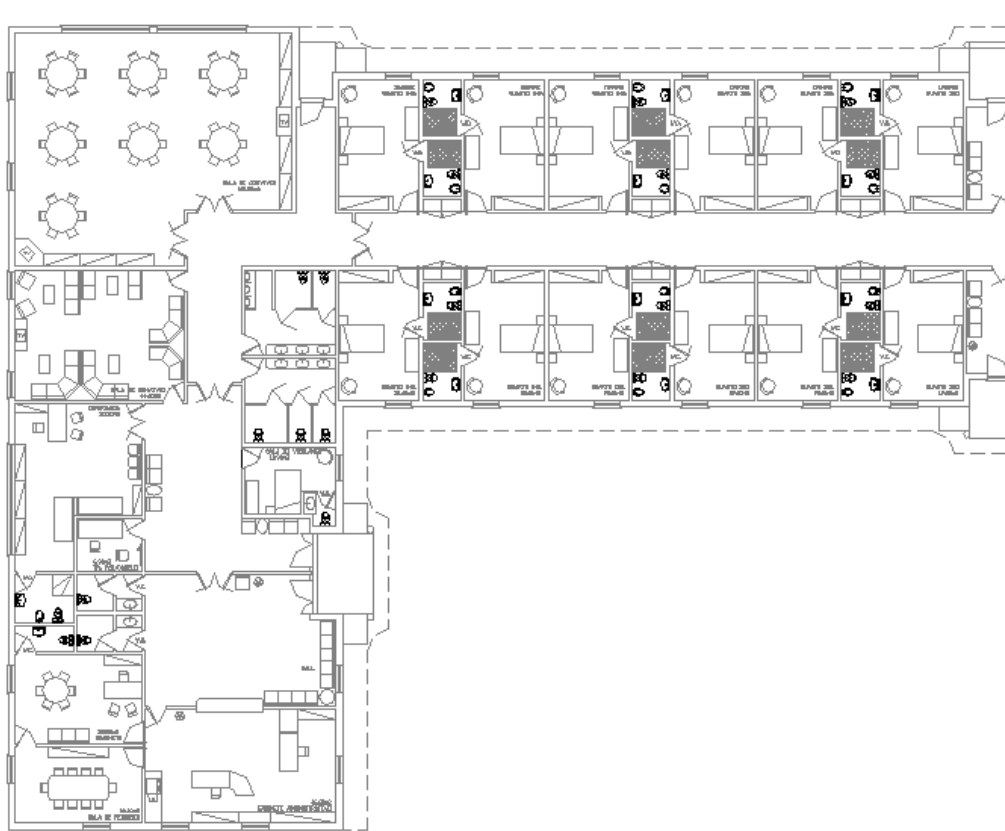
Detalhe vista em planta do estabelecimento.
